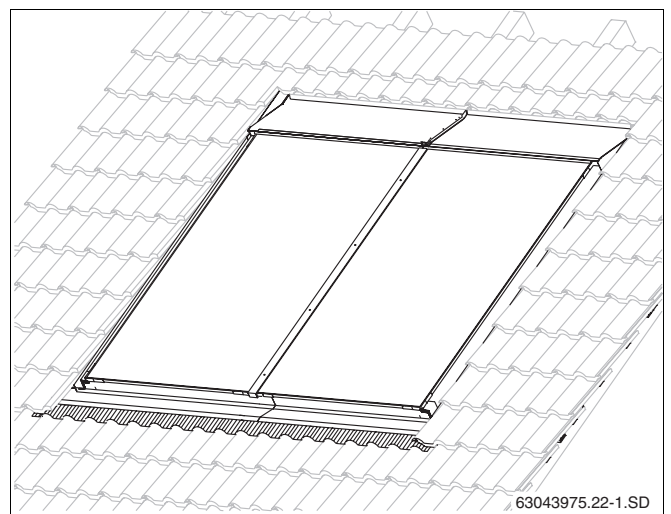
Vista general de dos colectores, montaje integrado en el tejado
